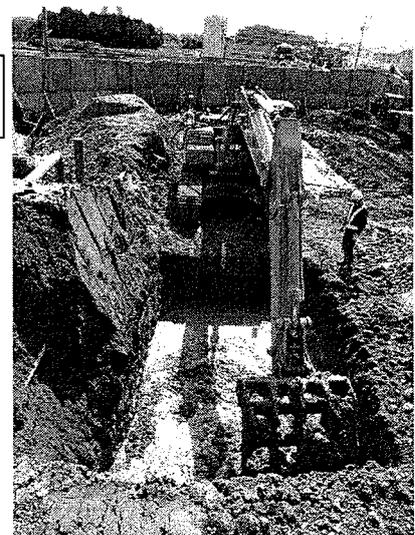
地盤改良状況 (エスミックスラリー工法)
